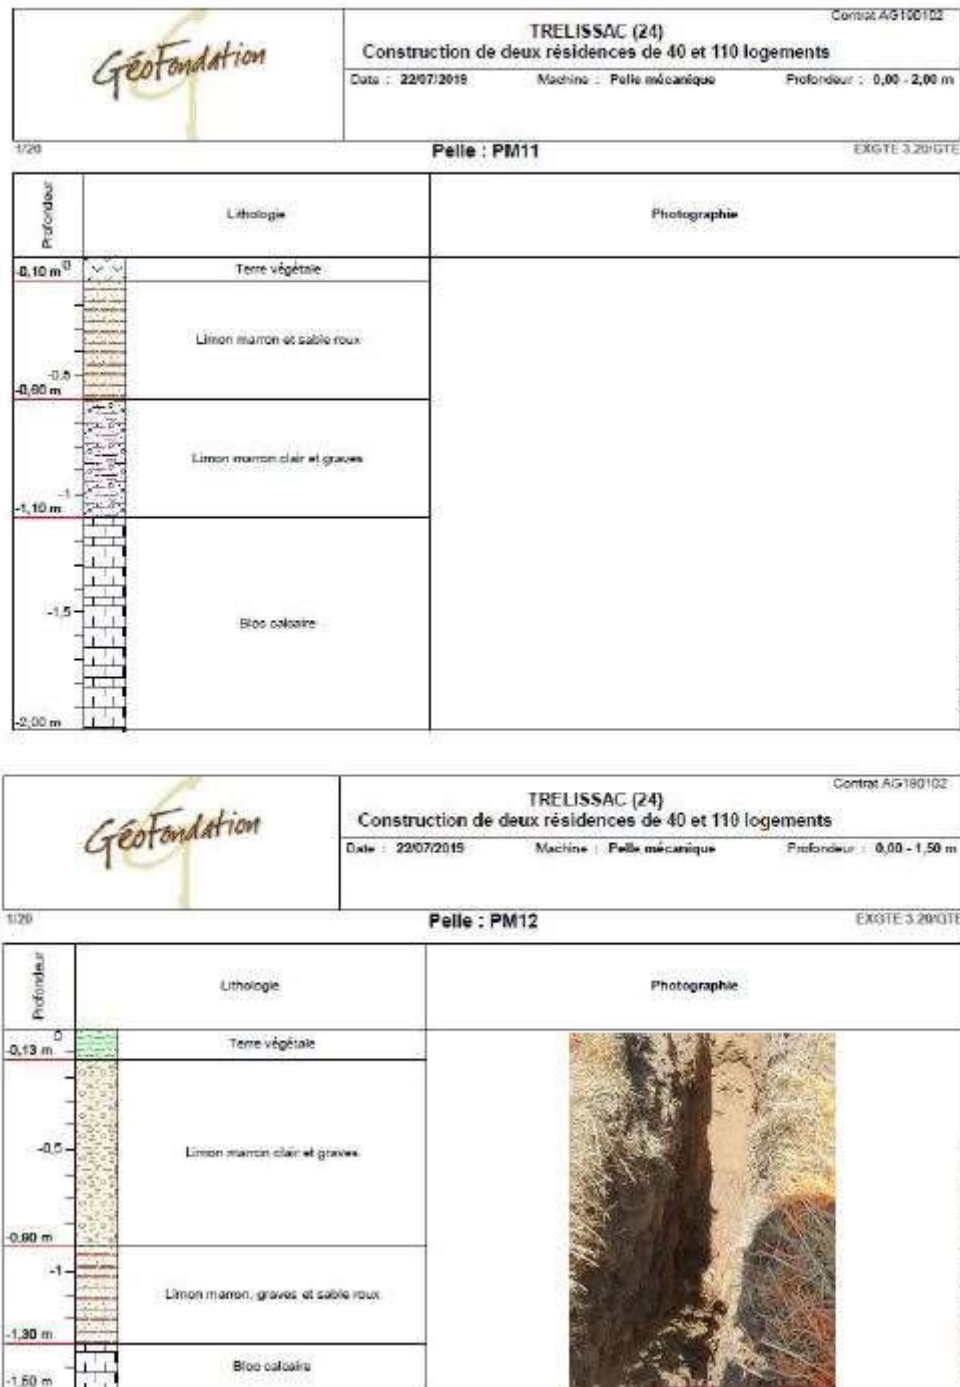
Extrait du rapport d'étude géotechnique GEOFONDATION n°AG190102
